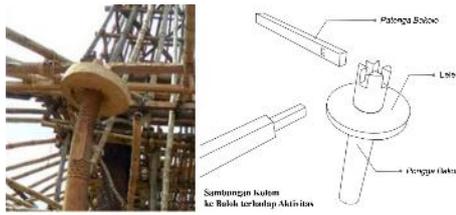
Lapisan bawah dan detail sambungan balok terhadap aktivitas
